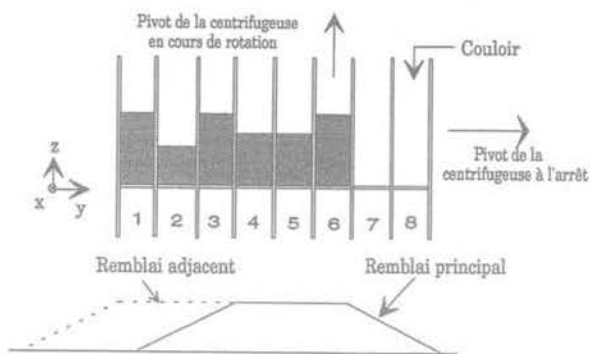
Coupe transversale des couloirs après remplissage (seconde variante).
